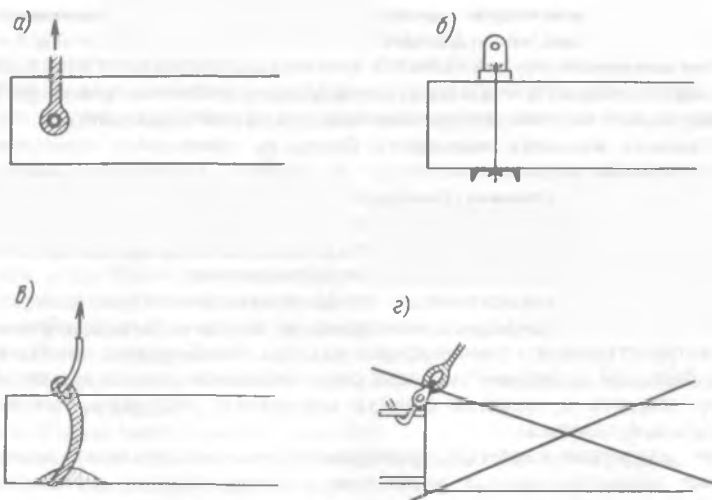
Варианты захвата сборных железобетонных и стеновых элементов
